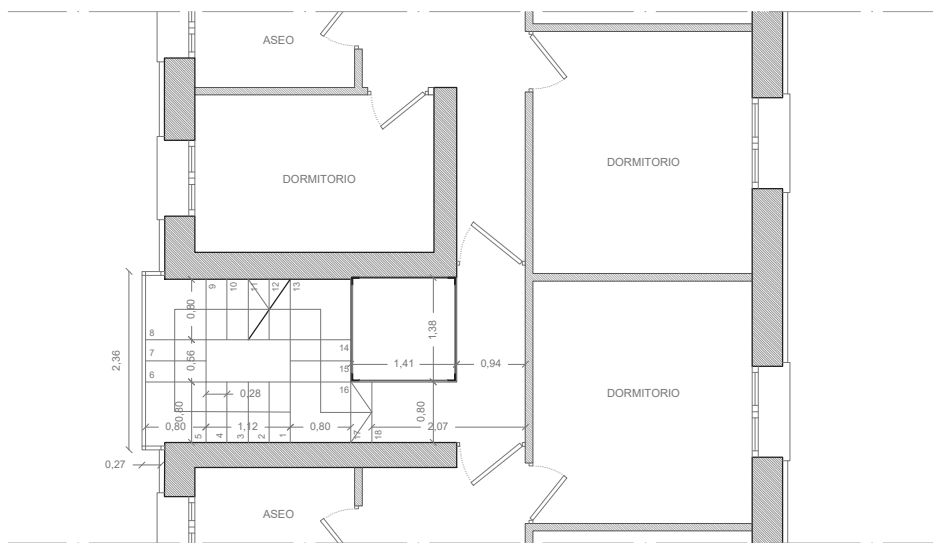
Zoom núcleo planta tercera (e: 1/100).
